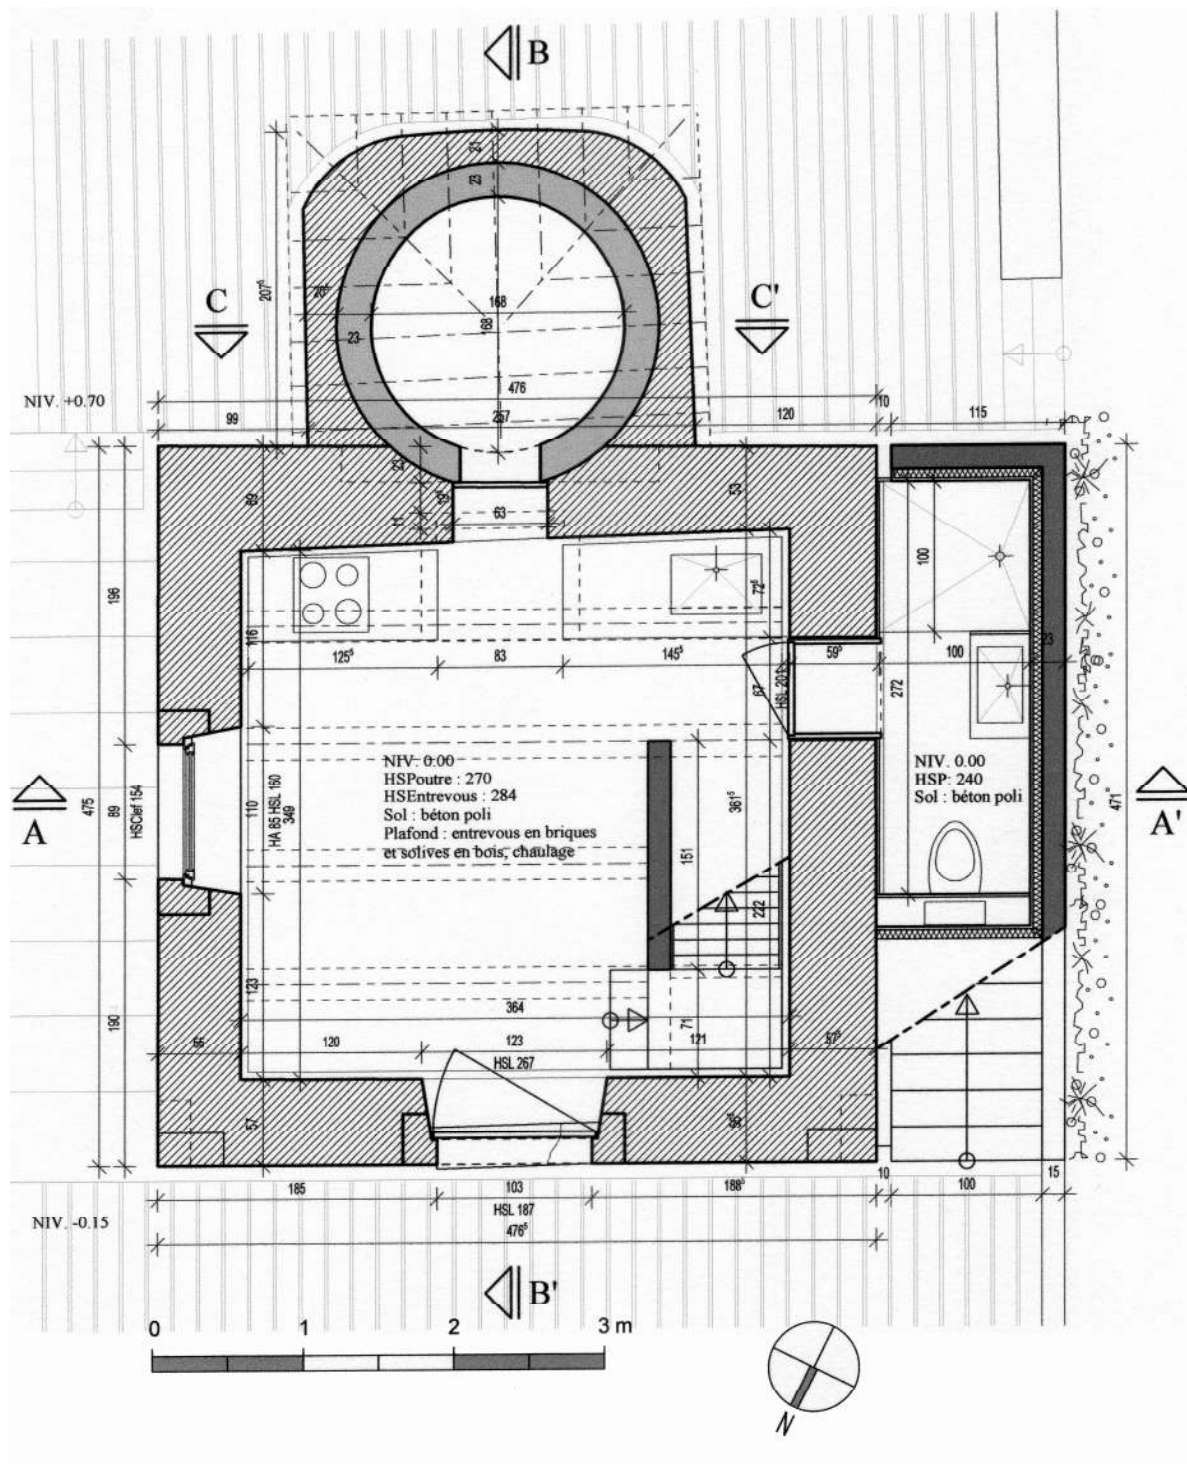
Pavillon et four. Vue en plan rez-de-chaussée. Ech. 1/50°. Situation projetée. IG 2008.
